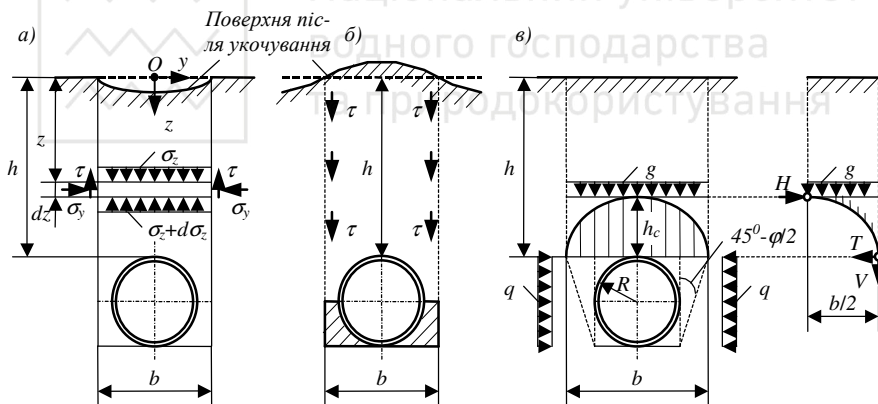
Схеми до розрахунку тисків ґрунту на підземні трубопроводи
